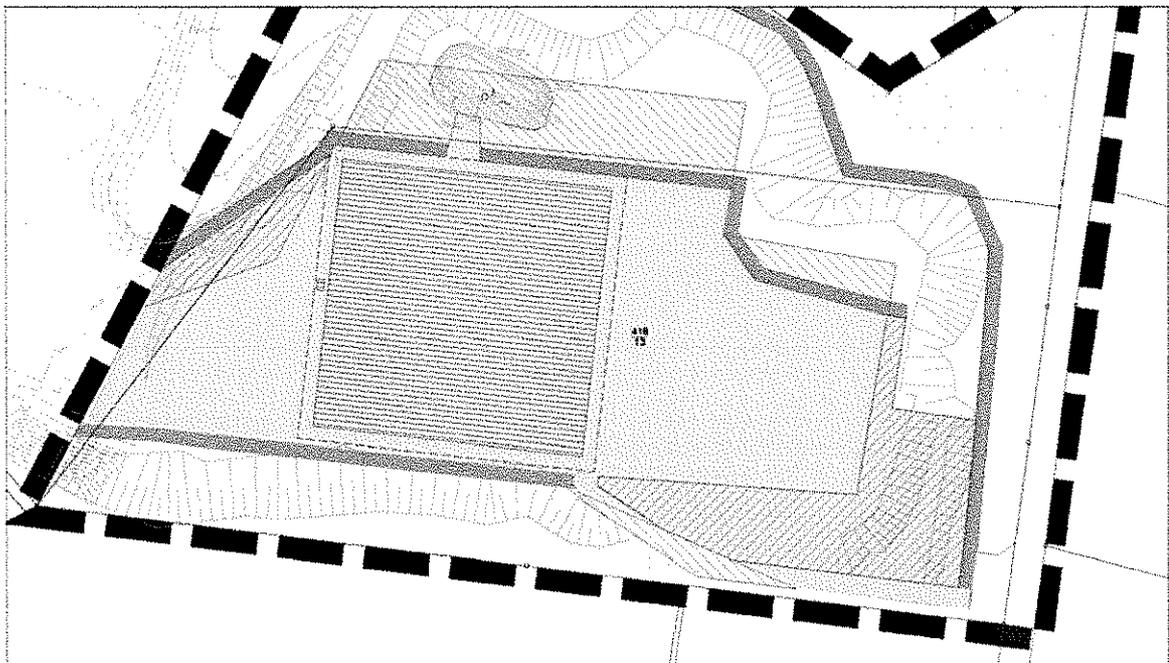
Änderungen: rote, diagonale Schraffur: neu als Baufläche festgesetzt; grüne Schraffur: bisherige Baufläche wird zurückgenommen
